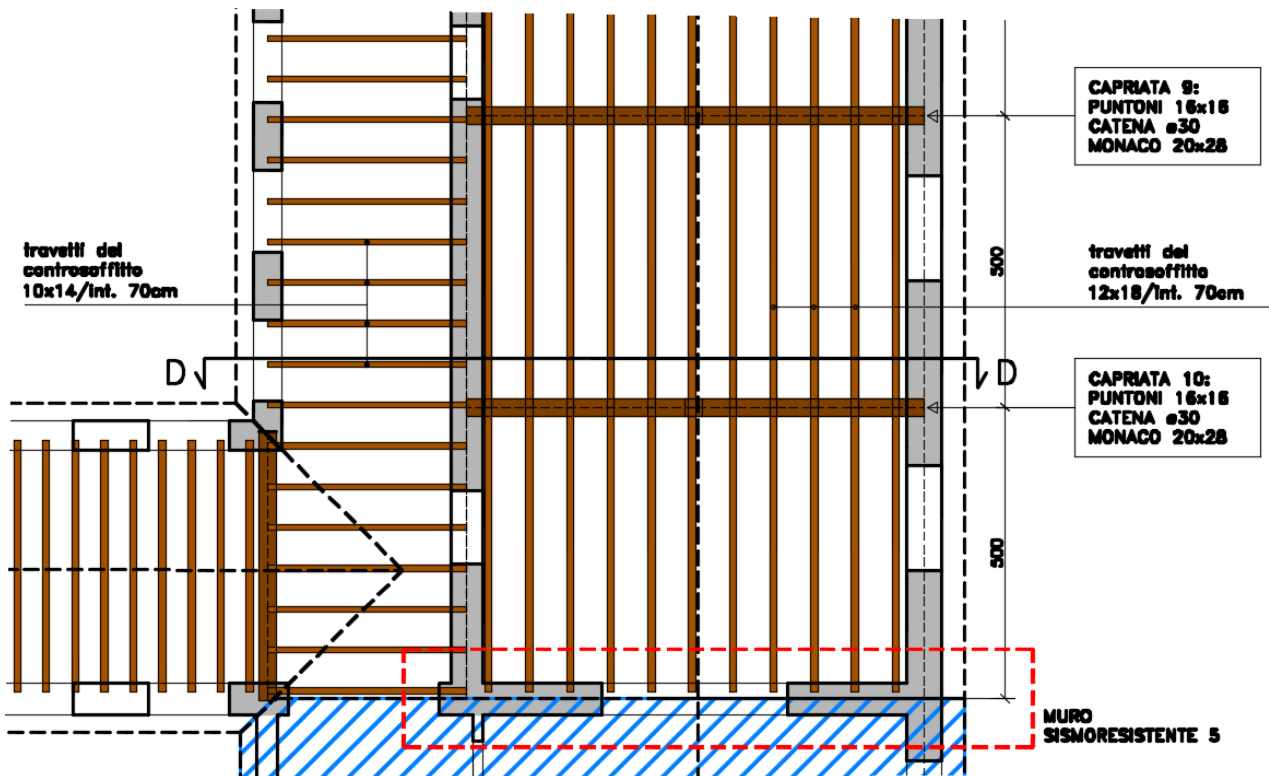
Pianta strutturale di porzione significativa della zona B degli elementi del solaio di sottotetto per individuazione degli elementi sottoposti a verifica
